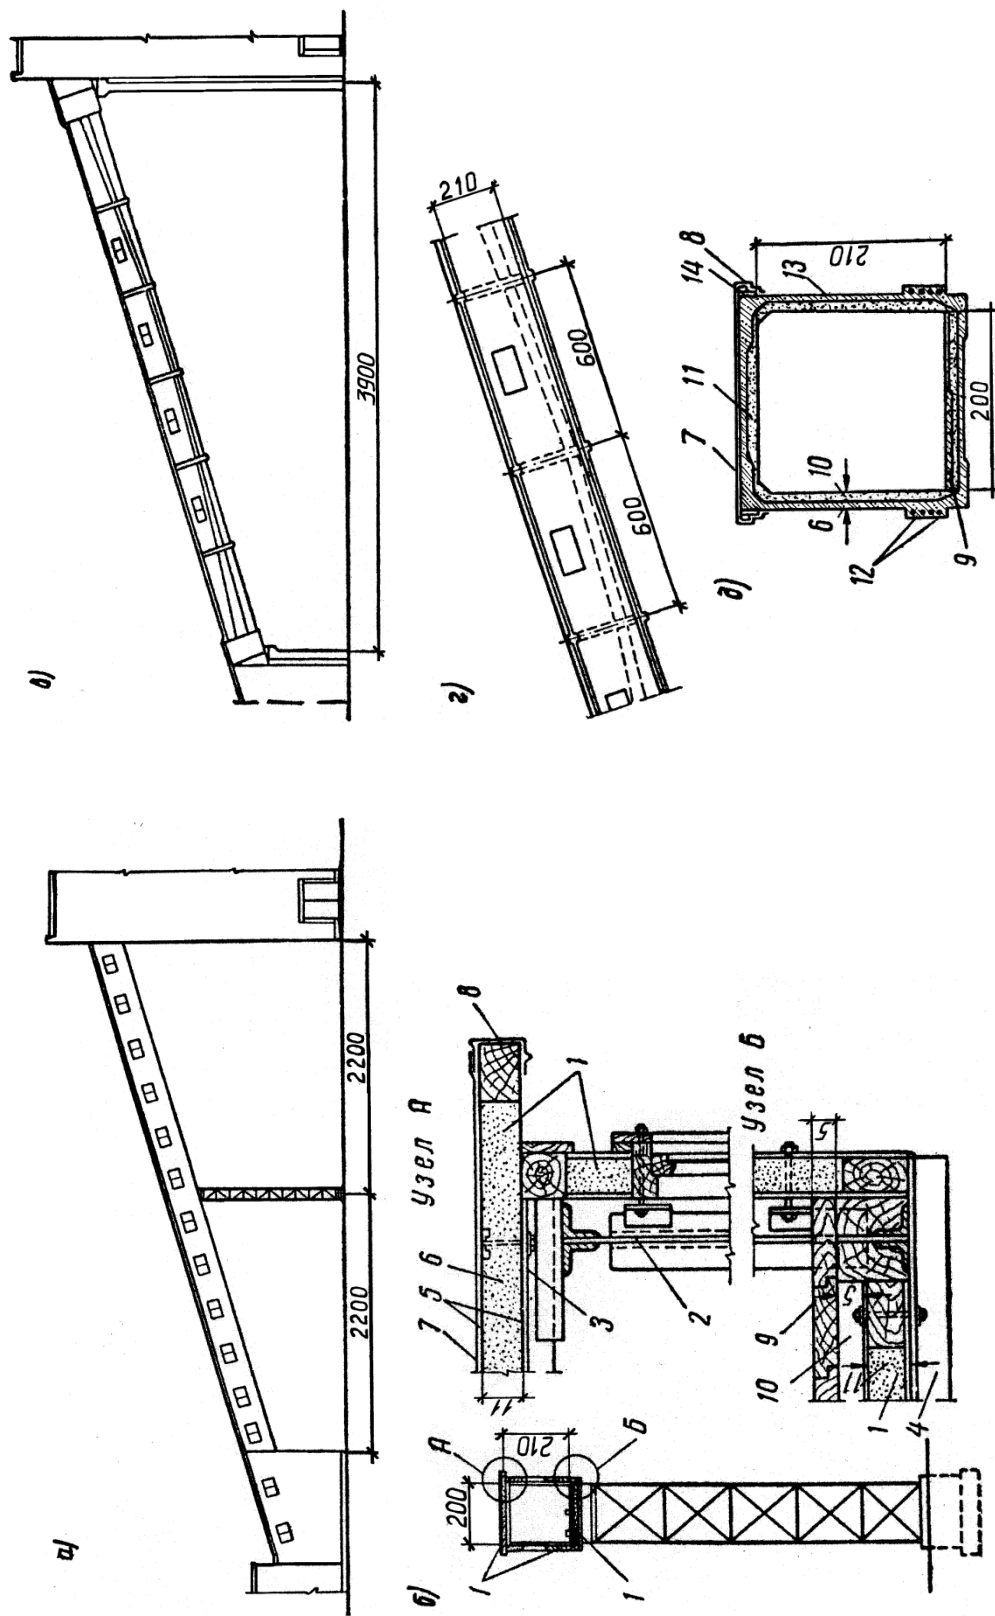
Транспортная галерея для подачи заполнителей: а – б – галерея из асбестоцементных щитов; а) фасад; б) поперечный разрез; в – д) однопролетная сборная железобетонная галерея; в) фасад; г) продольный разрез (фрагмент); д) поперечный разрез; 1 – щиты из асбестоцементных листов по деревянному каркасу; 2 – фермы; 3 – верхняя связь фермы; 4 – нижняя связь фермы; 5 – плоские асбестоцементные листы; 6 – в два слоя «крунам»; 7 – трехслойный рубероидный ковер; 8 – слив из оцинкованной стали; 9 – дощатый настил; 10 – лаги из брусьев; 11 – утеплитель (пенобетон); 12 – пучки проволоки из углеродистой стали; 13 – тонкостенные корыччатые железобетонные балки; 14 – доски для образования слива
